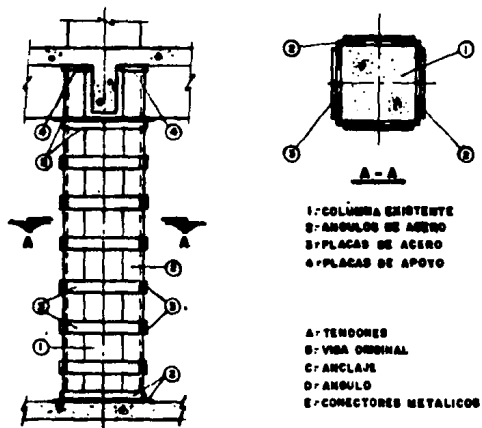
ENCAMIBADO METALICO DE COLUMNAS
